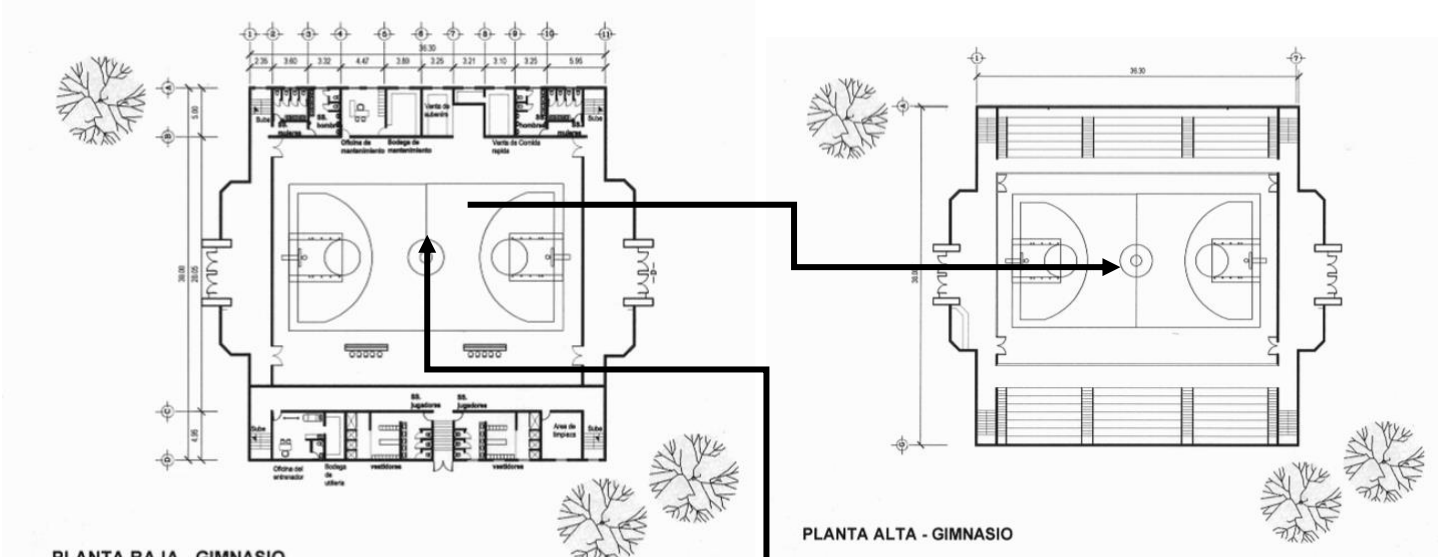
PLANTA BAJA DE GIMNASIO
